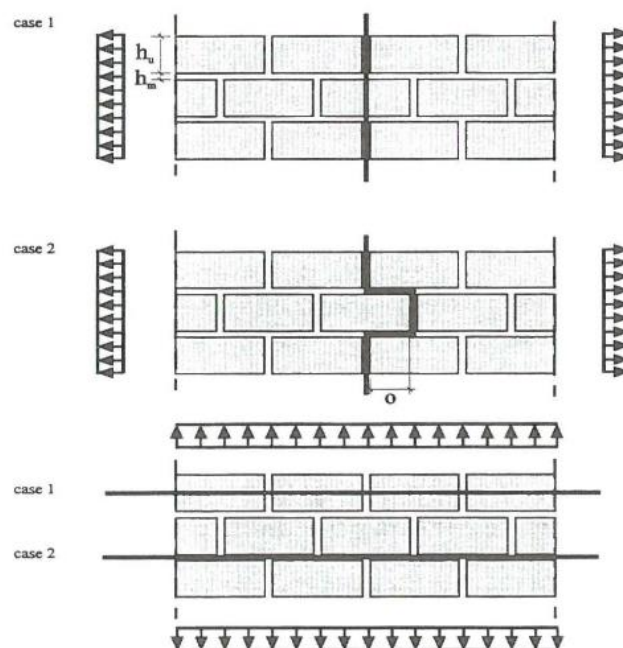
Fissurations possibles pour une maçonnerie en traction parallèle ou perpendiculaire au joint horizontal (Schubert, 1994)
